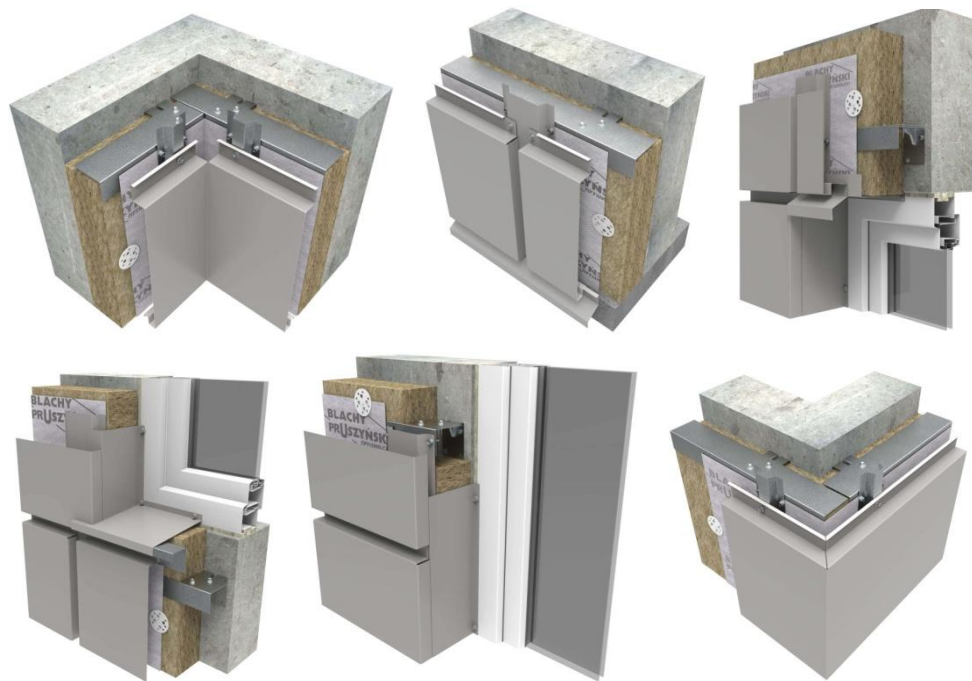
Типові вузли обшивки існуючої будівлі фасадними касетонами з утепленням
